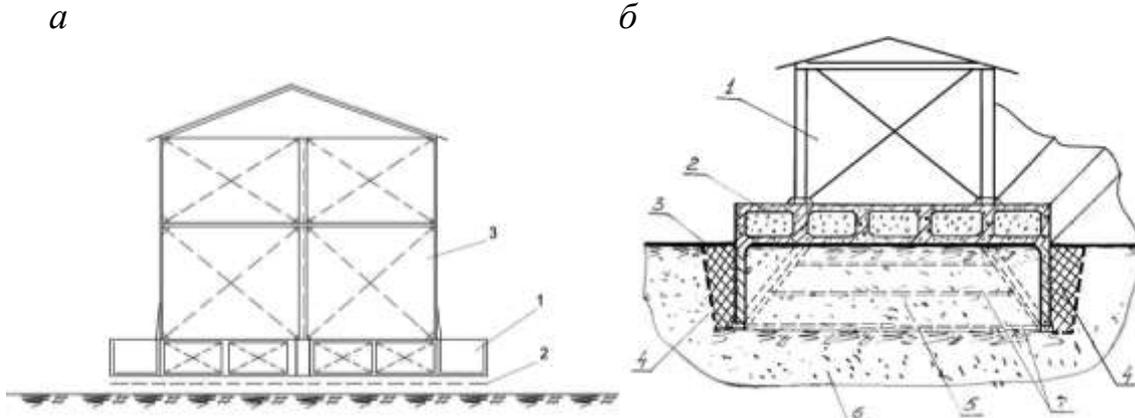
Примеры малоэтажных зданий замкнутого типа для строительства в сейсмических районах в сложных грунтовых условиях, объединенных с пространственной фундаментной платформой:
